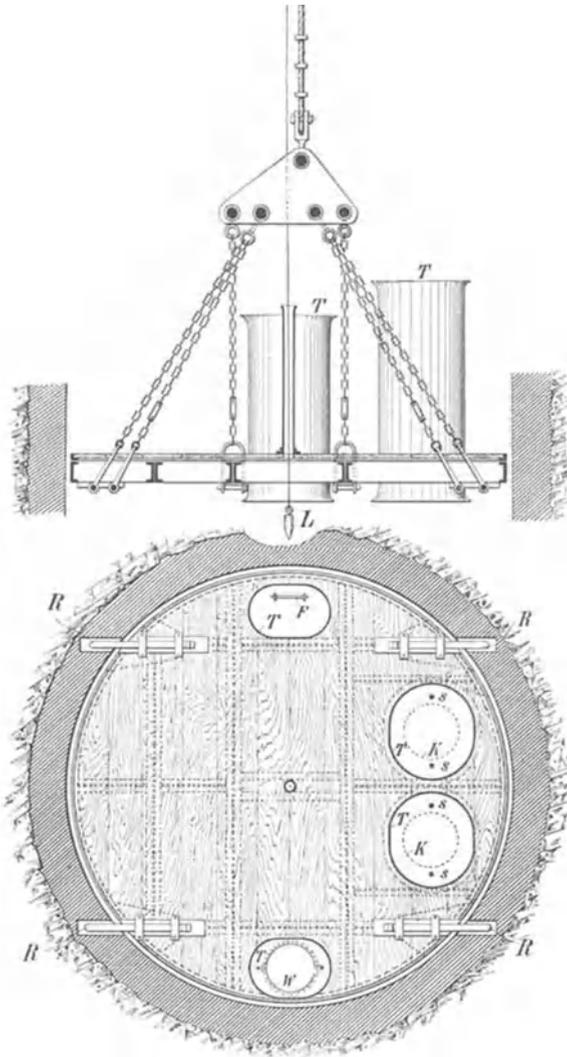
Exzentrisch aufgehängte, schwebende Bühne der Maschinenfabrik H. u. G. Großmann zu Dortmund für gleichzeitiges Ausmauern und Abteufen.
